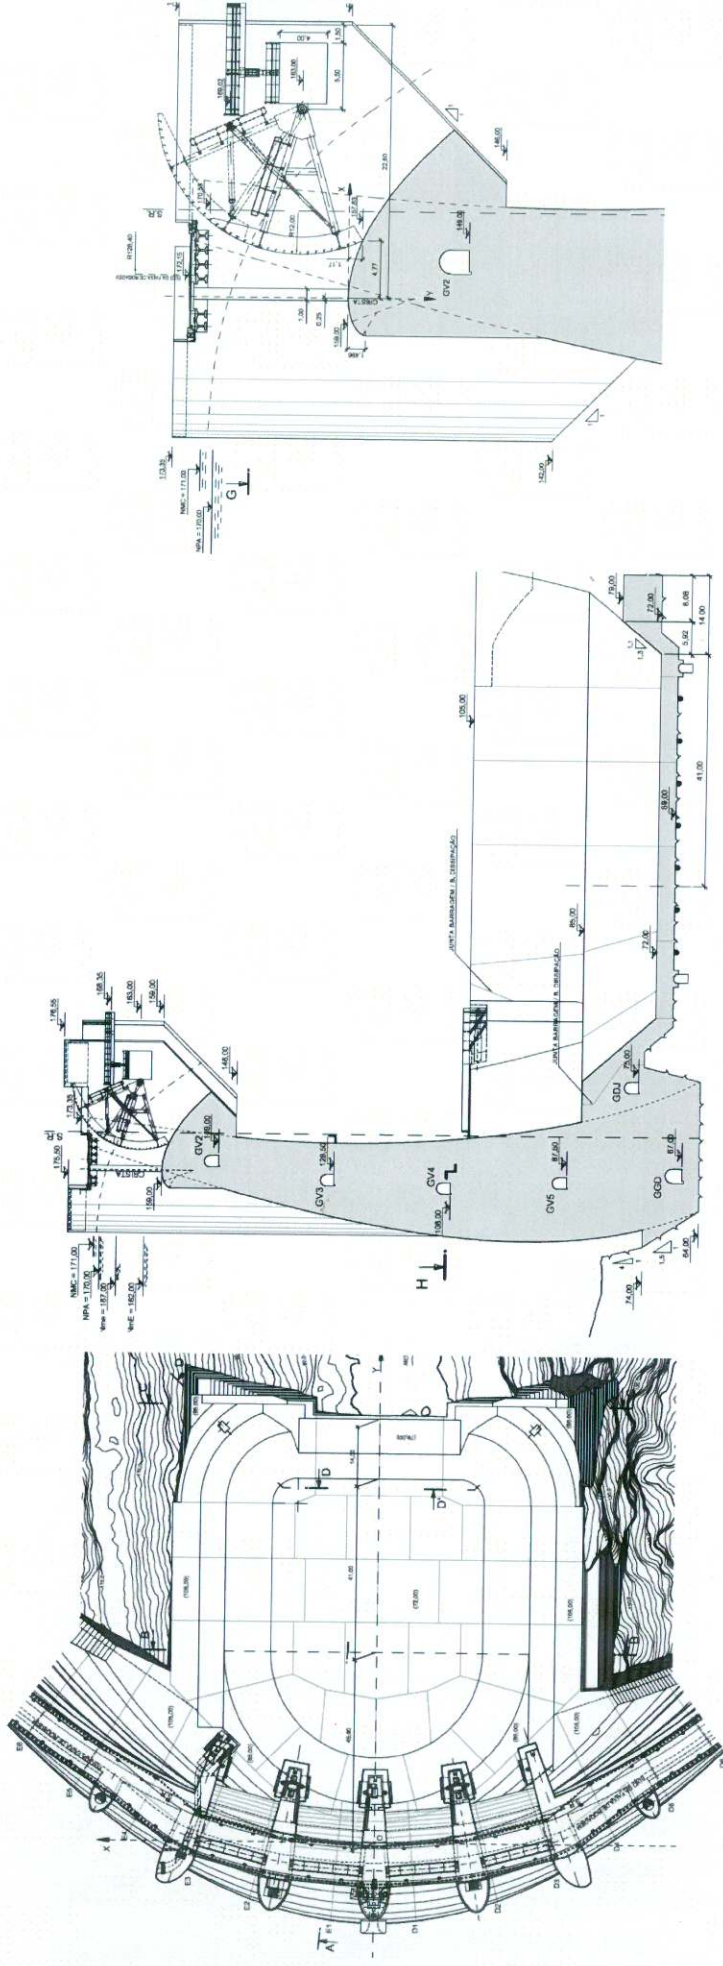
Descarregador de cheias – Planta e cortes A-A e F-F do Projecto (Fonte EDP).
